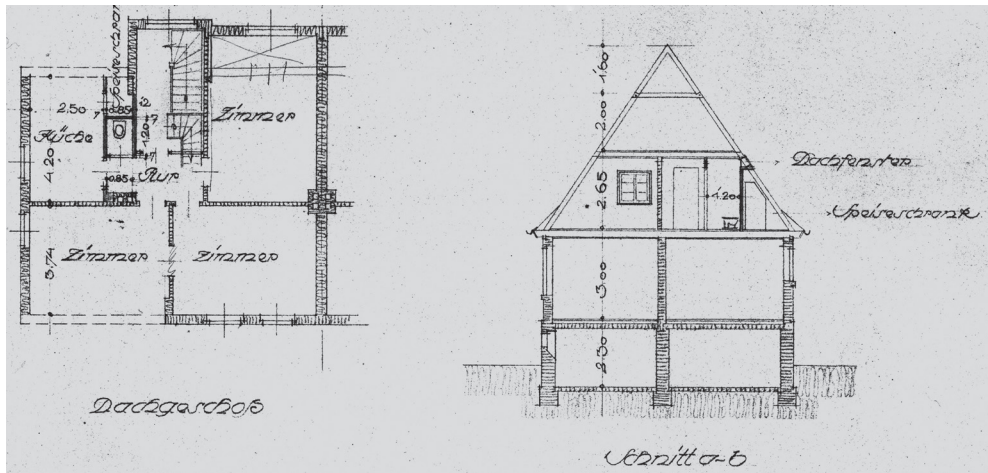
Kleine Häuser in einfachster Bauweise: Bauzeichnung eines Hauses im Querschnitt und Grundriss der Dachgeschosswohnung [StA SP]
